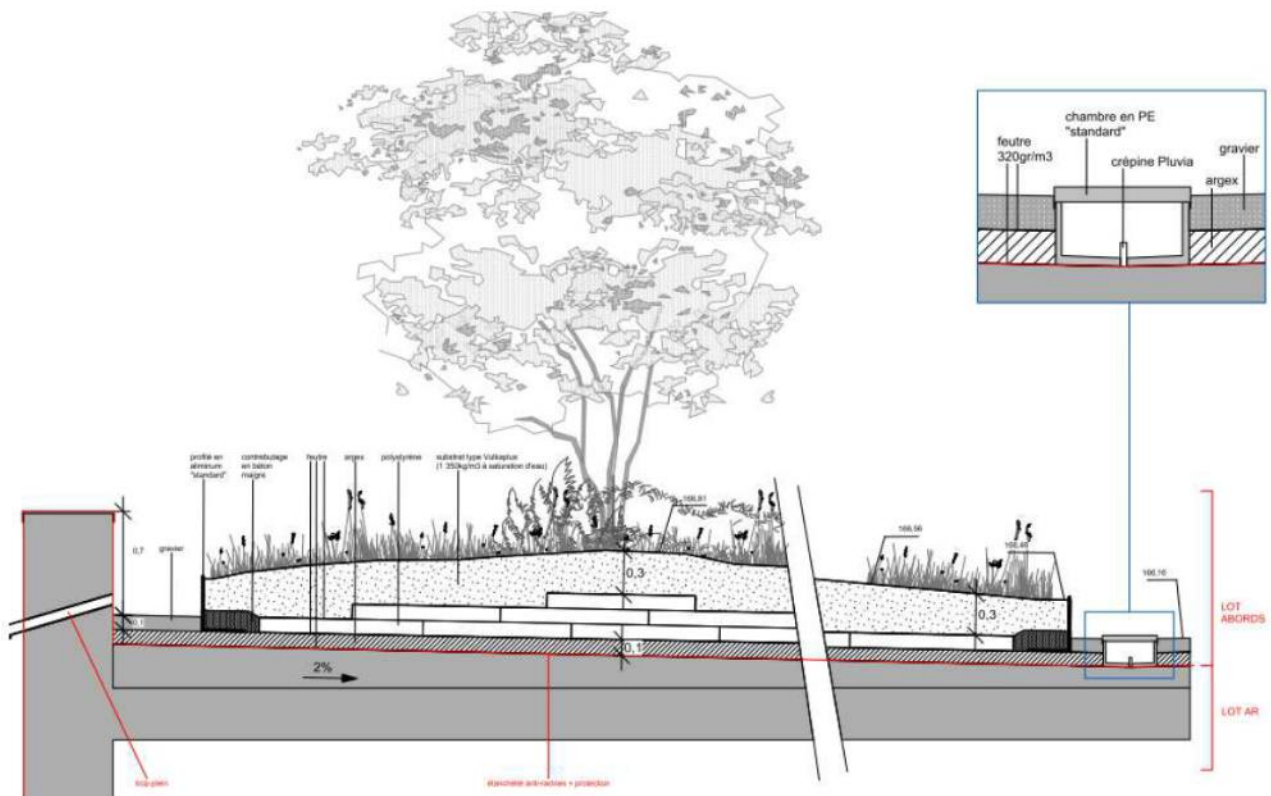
Coupe toiture ensemble 2 (source : JNC International, 2021)
